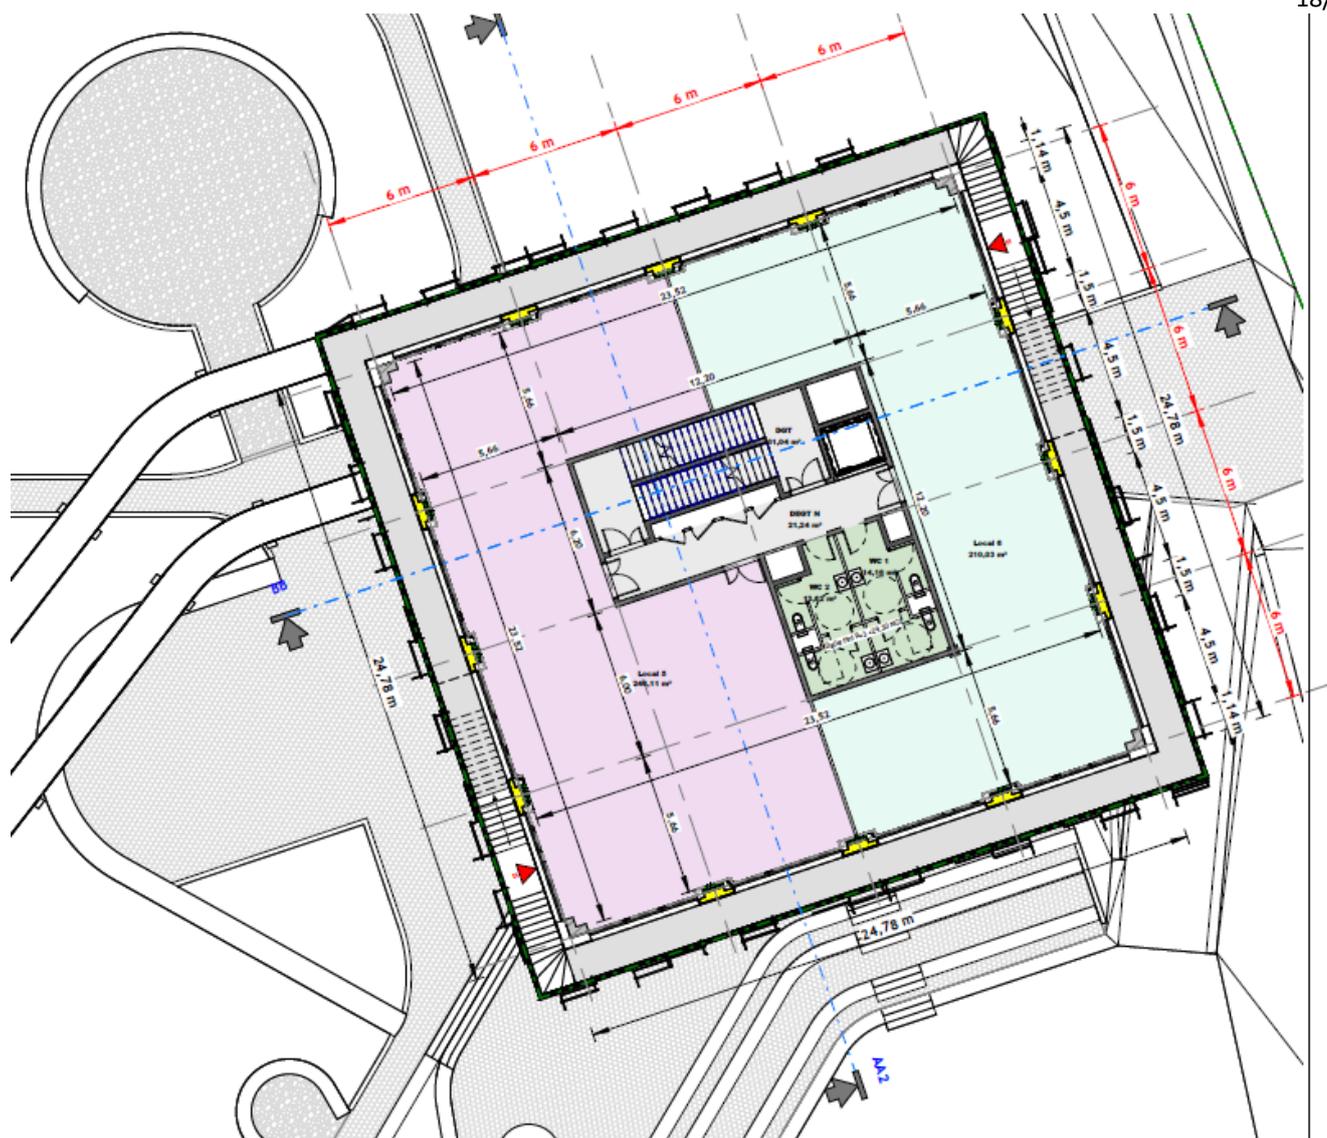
Plan de pavillon – niveau R+3 (février 2024)
